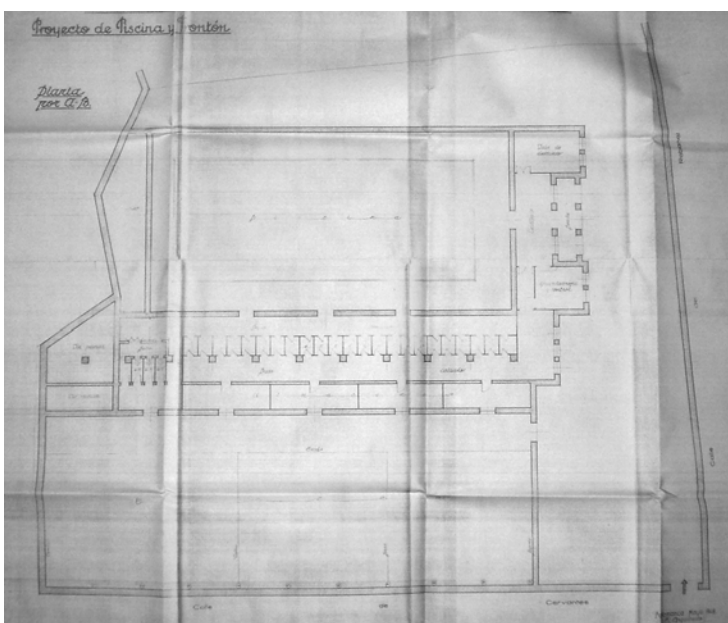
Proyecto de piscina y frontón: planta baja, por G. de No Hernández, mayo 1946.
